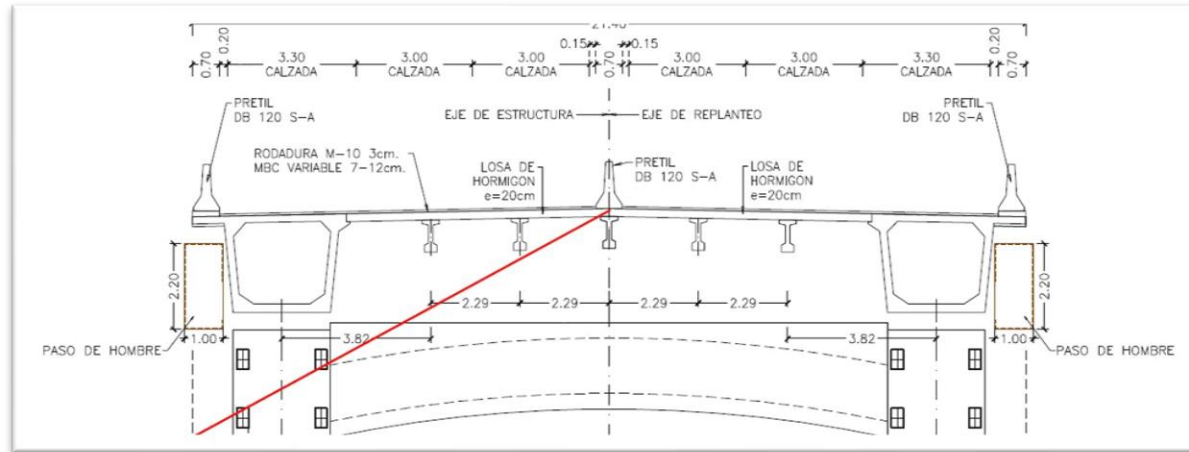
Imagen de la sección tipo proyectada generada sobre la pila 17
